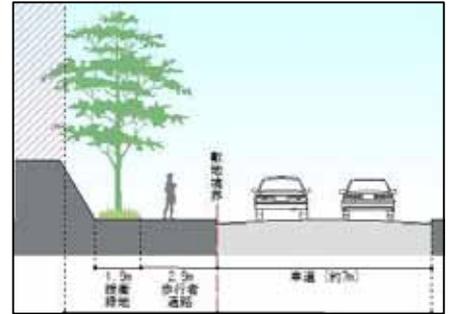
(1) 地区内幹線道路の標準断面及び縦断面図
